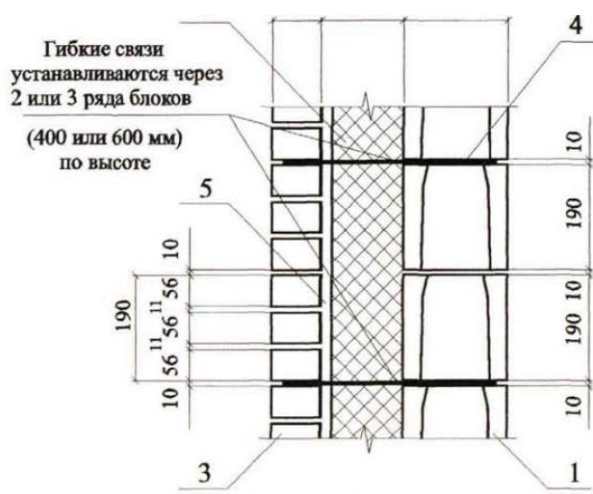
Схема наружной трехслойной стены на основе вибропрессованных бетонных блоков:
